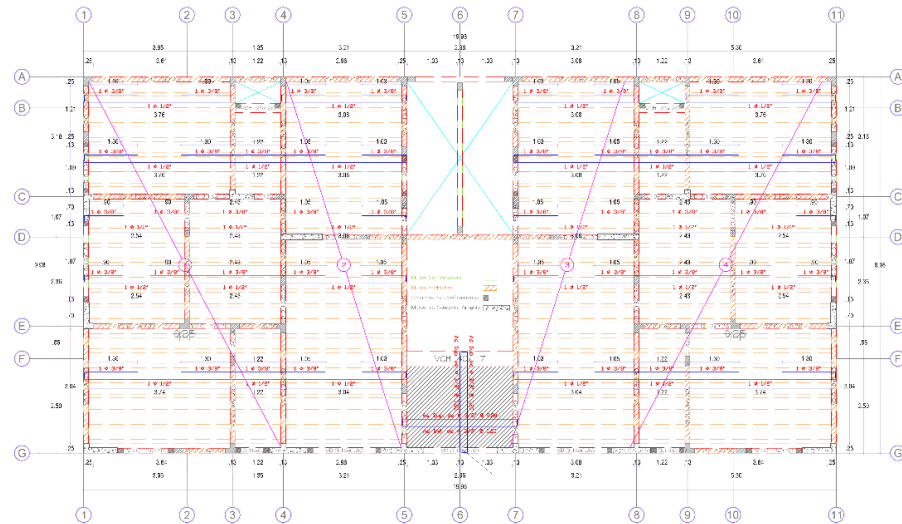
Estructuración del Sistema Estructural de Albañilería Confinada.
